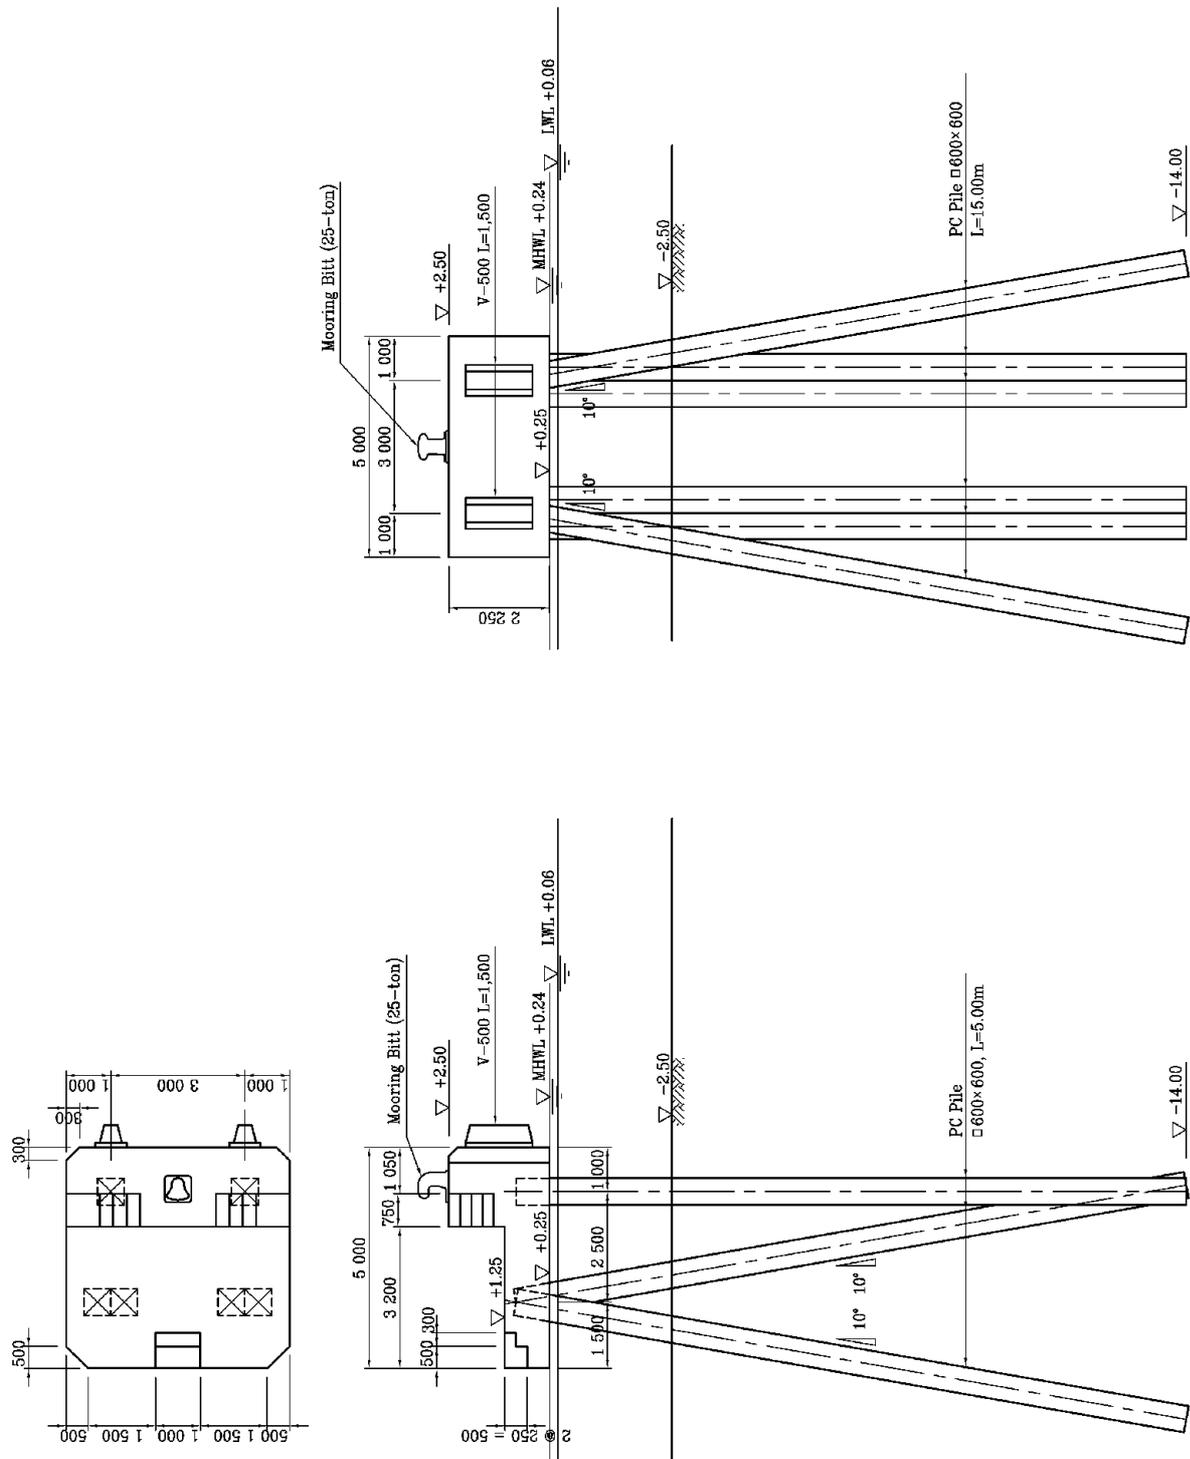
Plan Típico y Sección de Estructura de Amarré Dolfín
